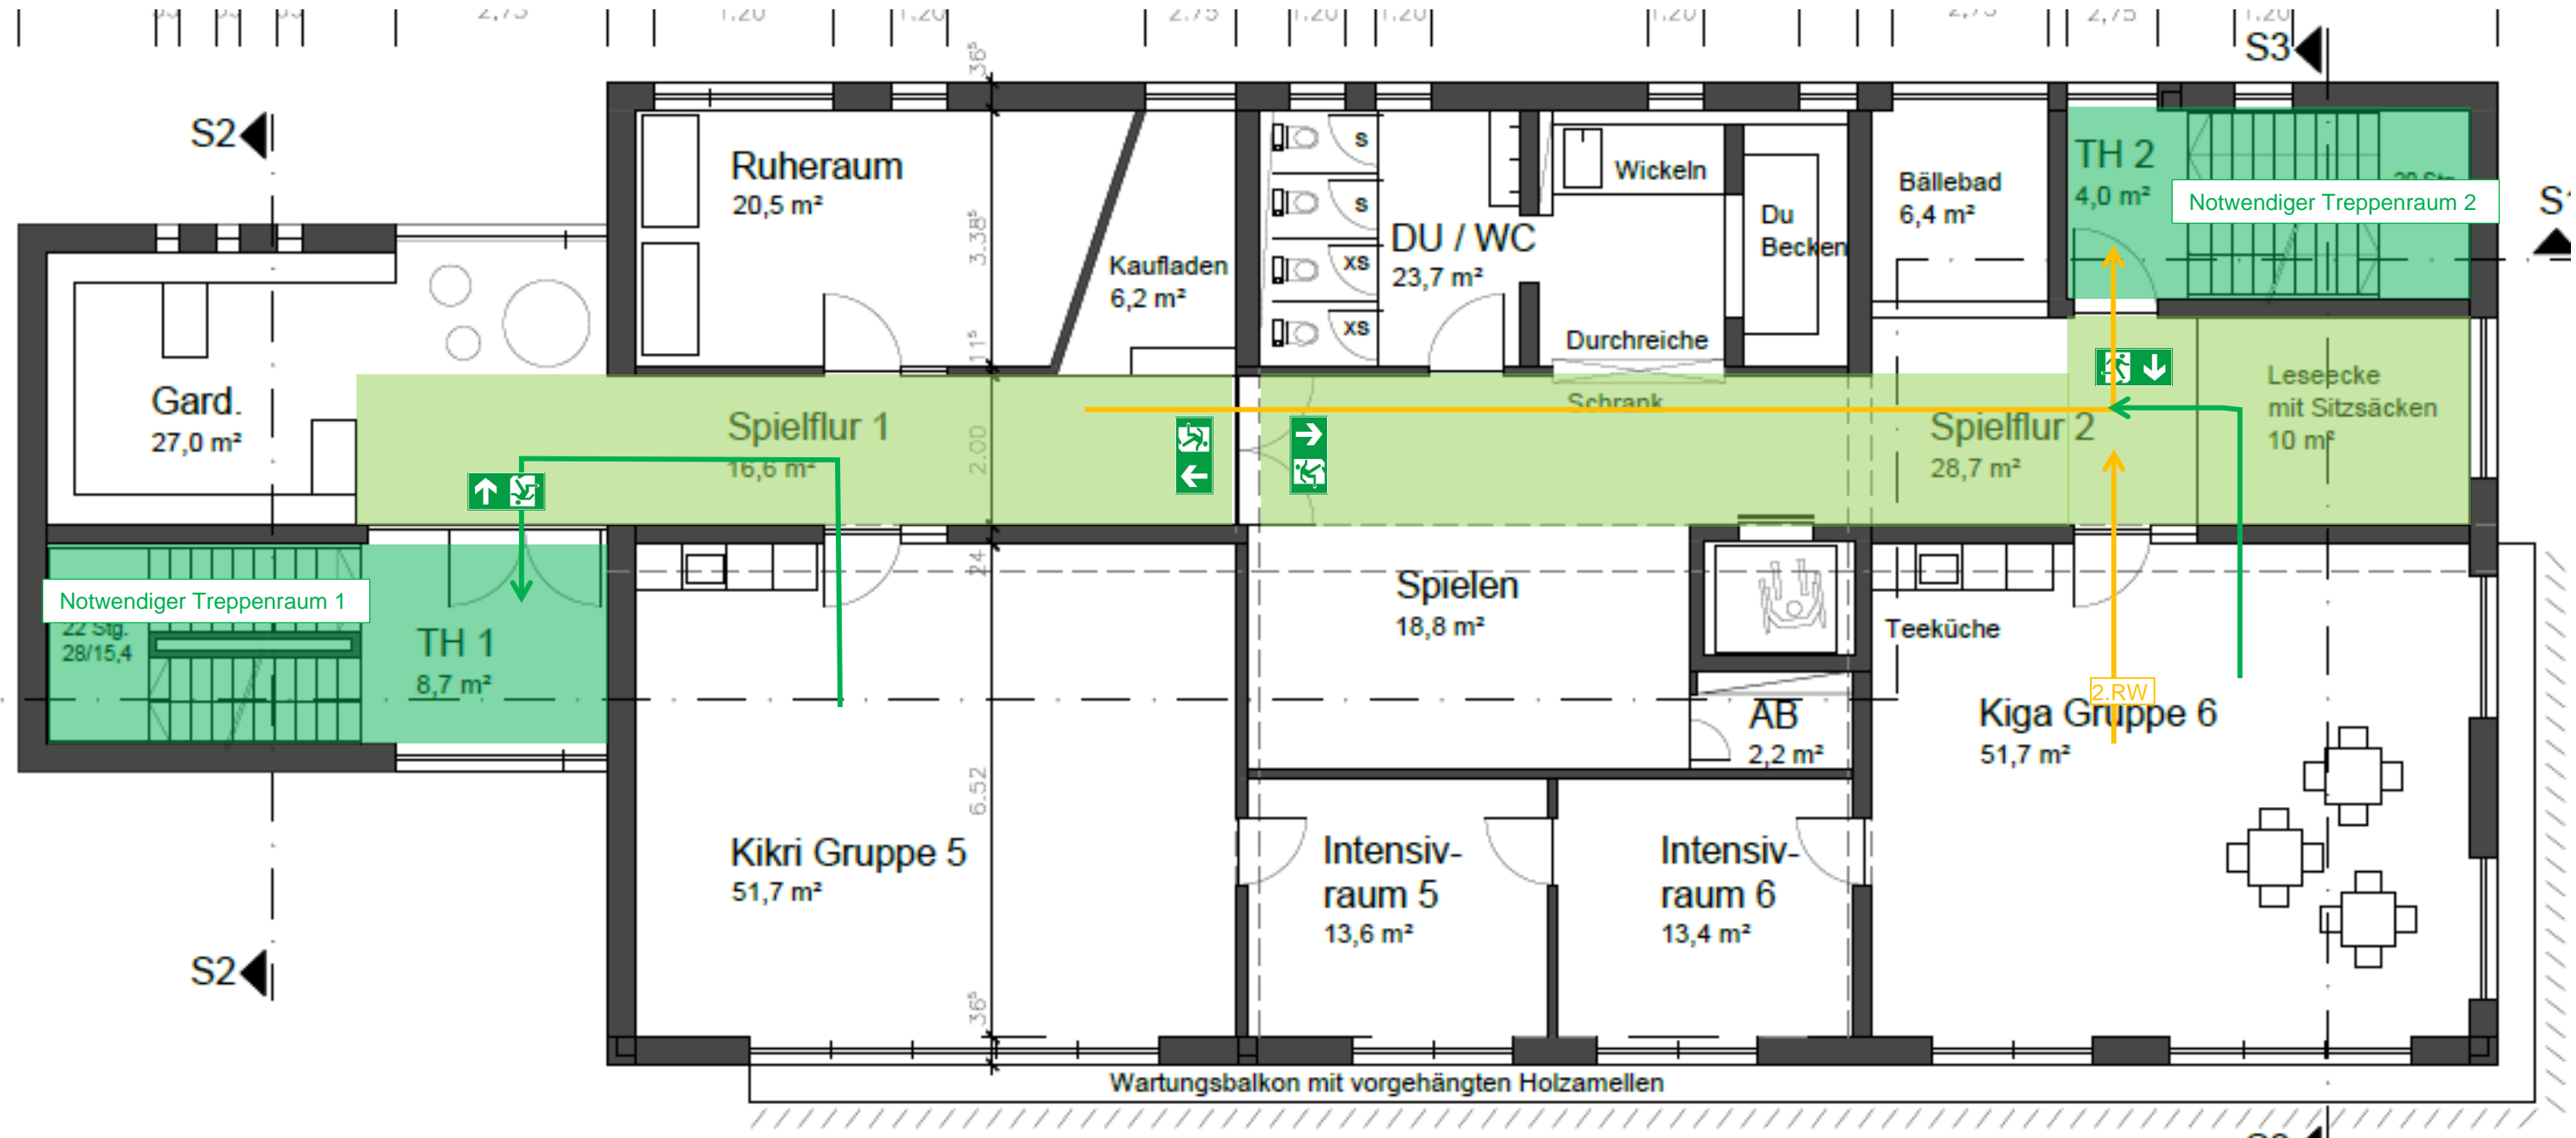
Grundriss 2. Obergeschoss
